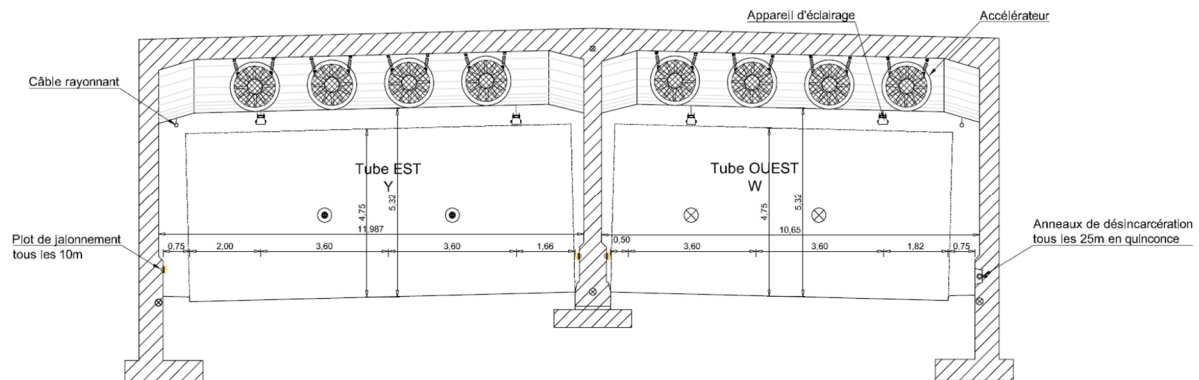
Section transversale tranchée couverte au droit des bossages des ventilateurs
